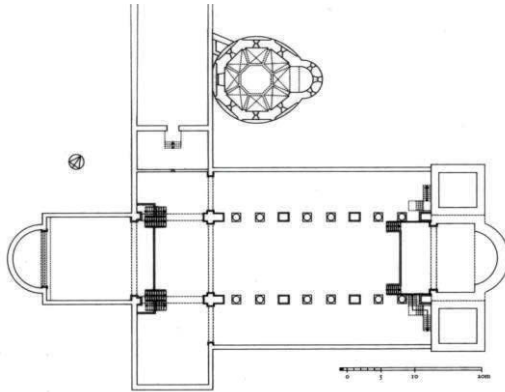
Bamberg, Dom: Grundriss des Heinrichsdoms mit der an das nördliche Querhaus anschließenden Andreaskapelle, um 1047, nach Walter Sage
